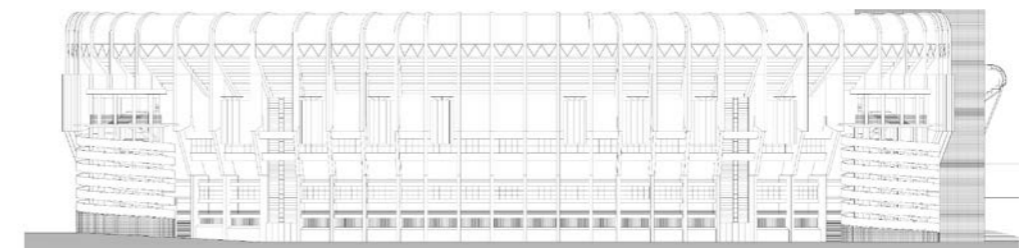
Alzado sur del Santiago Bernabéu tras la reforma de 2002.
